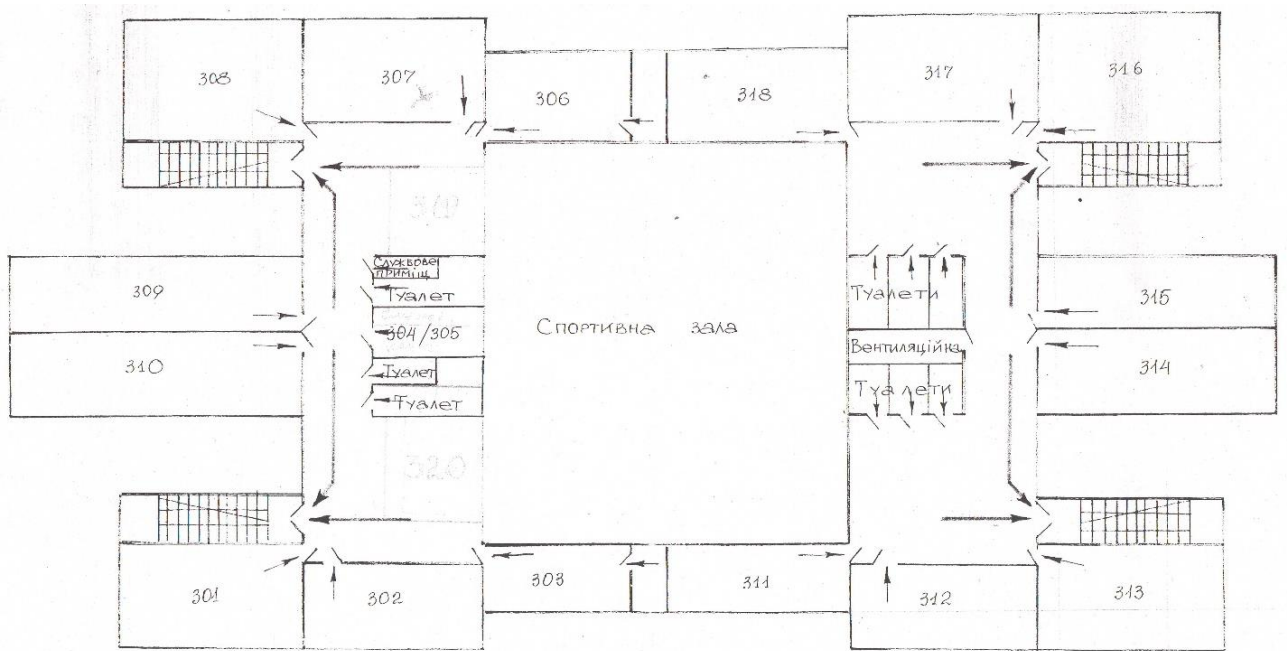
План 3-го поверху БАЛ «Гармонія»
